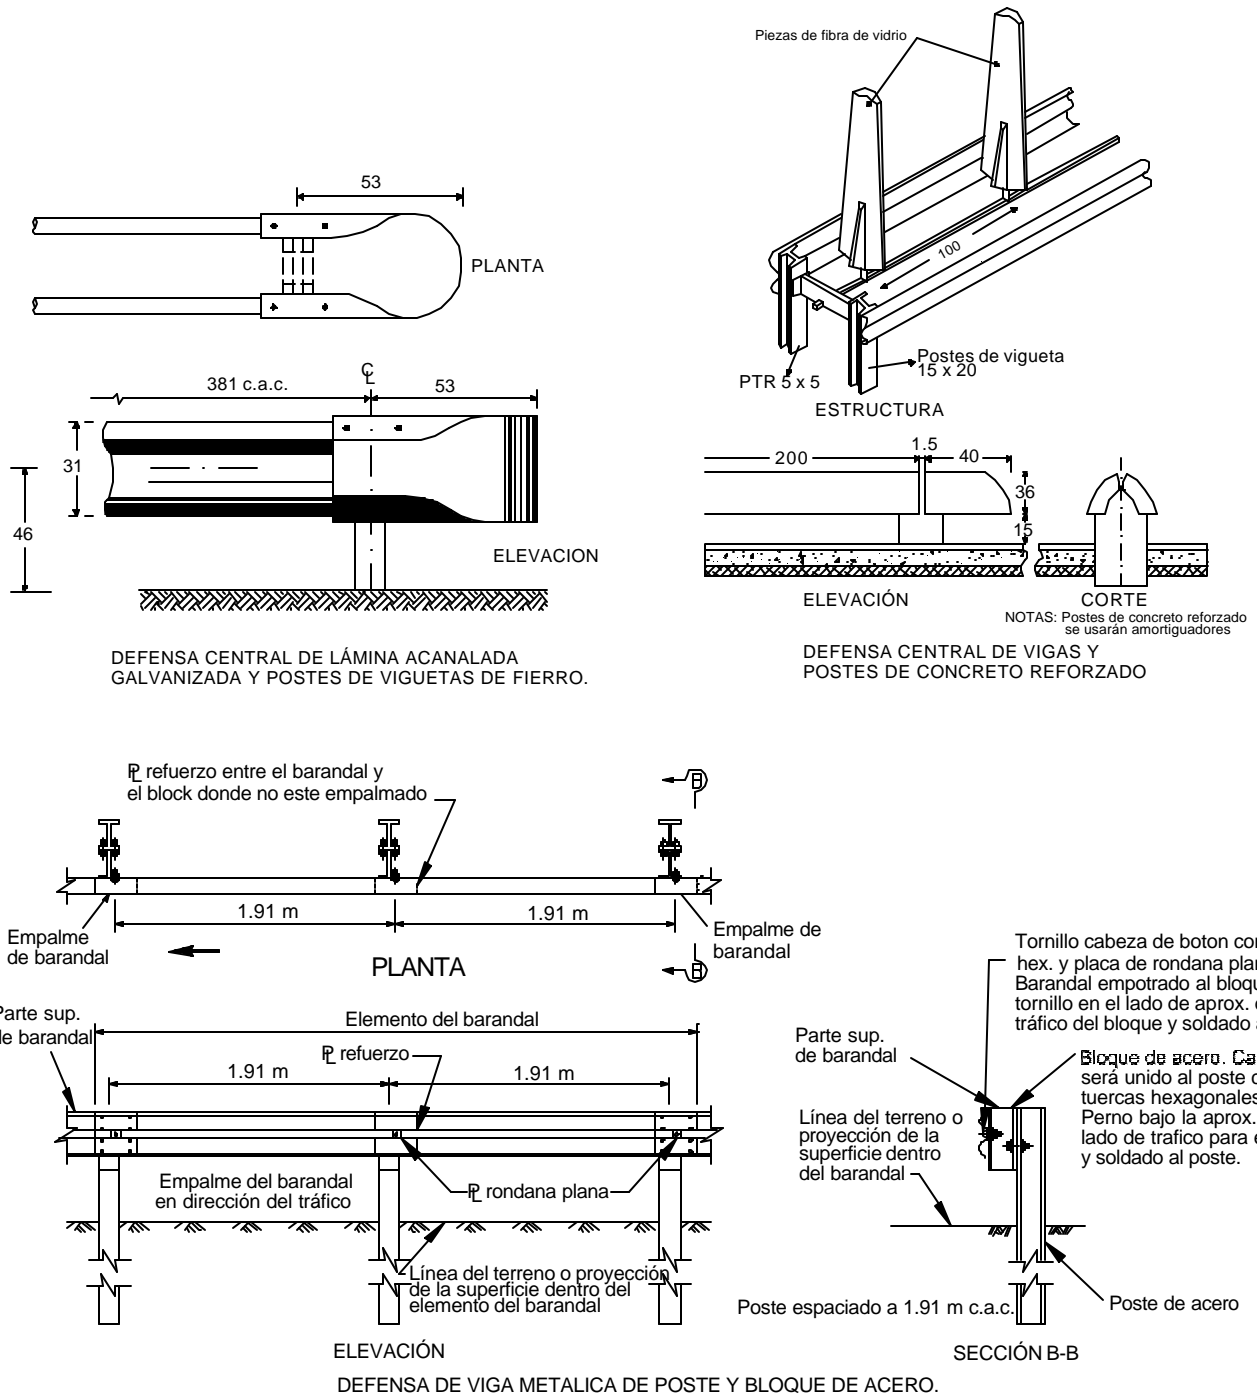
Defensas centrales metálicas y de concreto con piezas antideslumbrantes.
